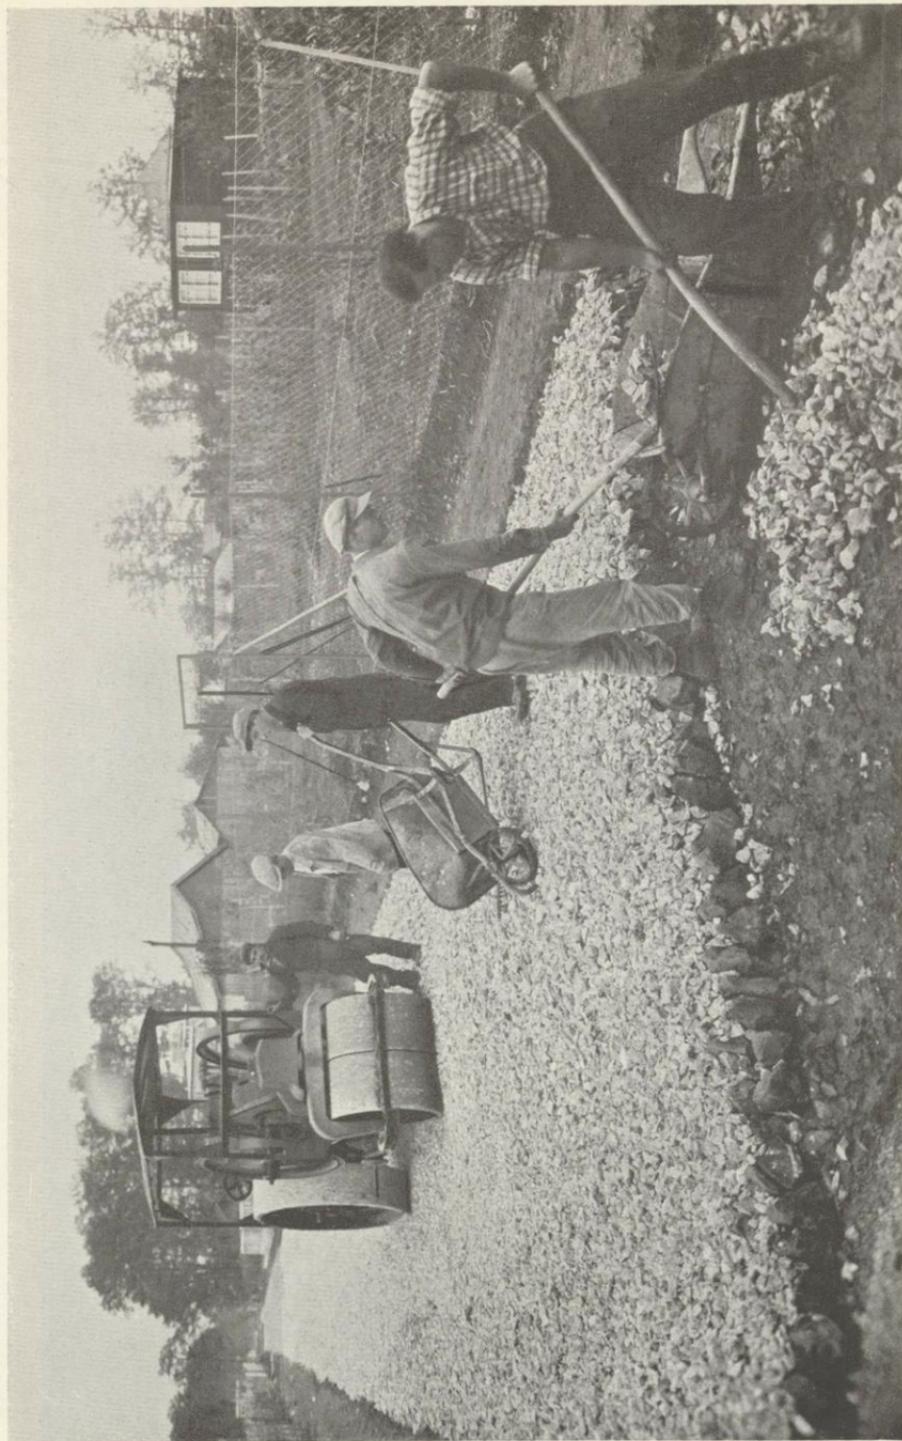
Freiwilliger Arbeitsdienst; Straßenbau für den Siedlungsaufbau; Baustadium II
